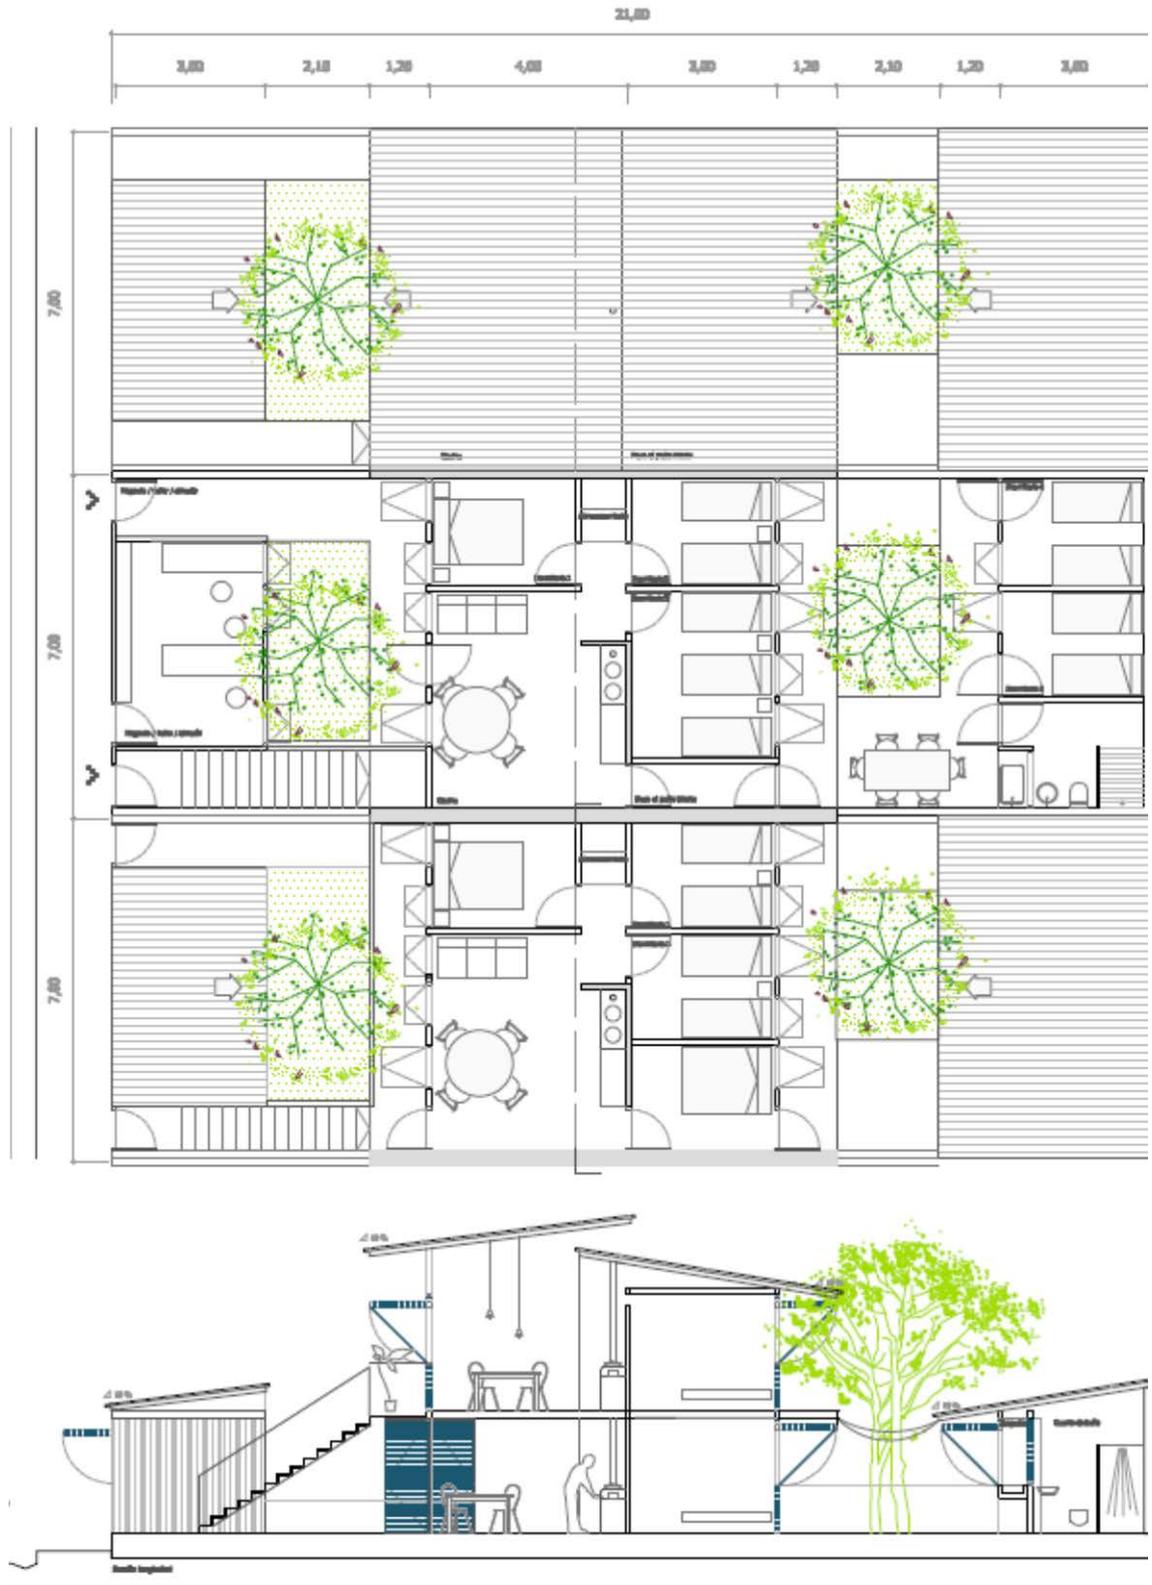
Esquema de la quinta y última fase de construcción de la vivienda
